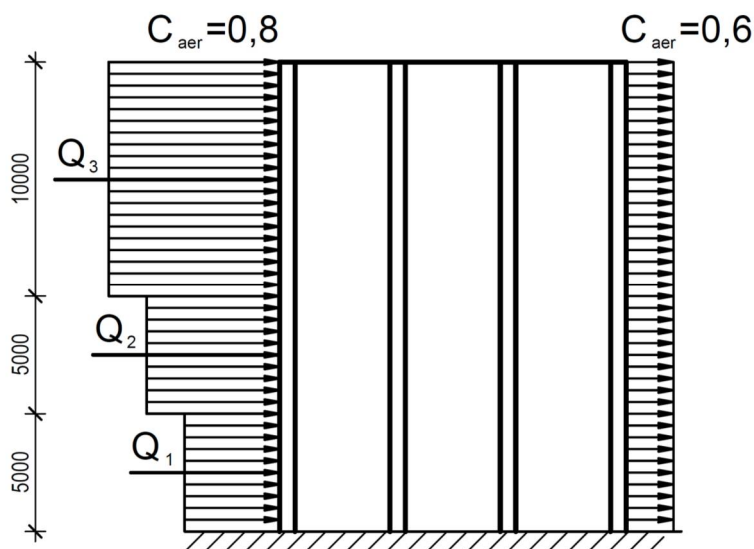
Розрахункова схема будівлі в цілому при дії вітрового навантаження
